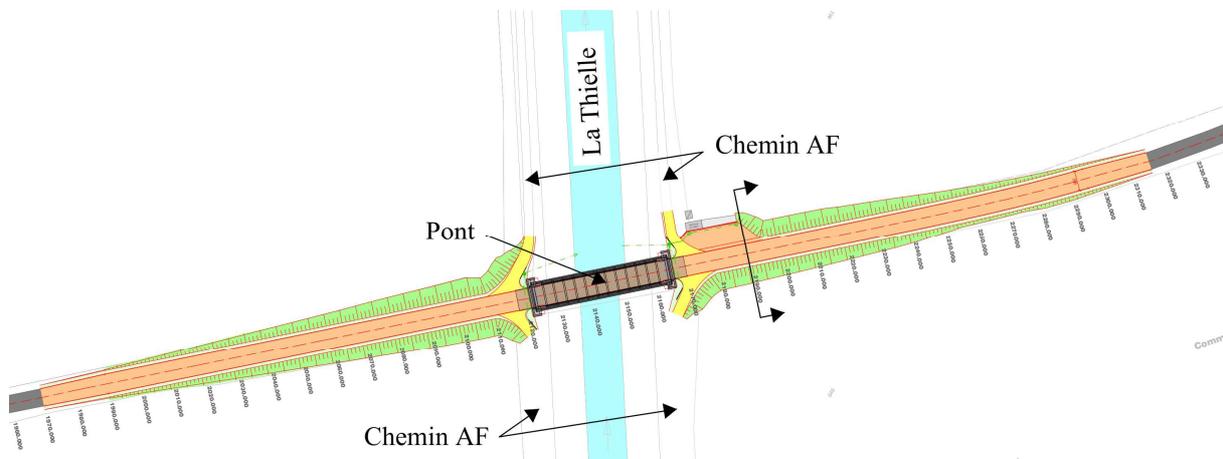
Situation pont sur la Thielle avec rampes d'accès
